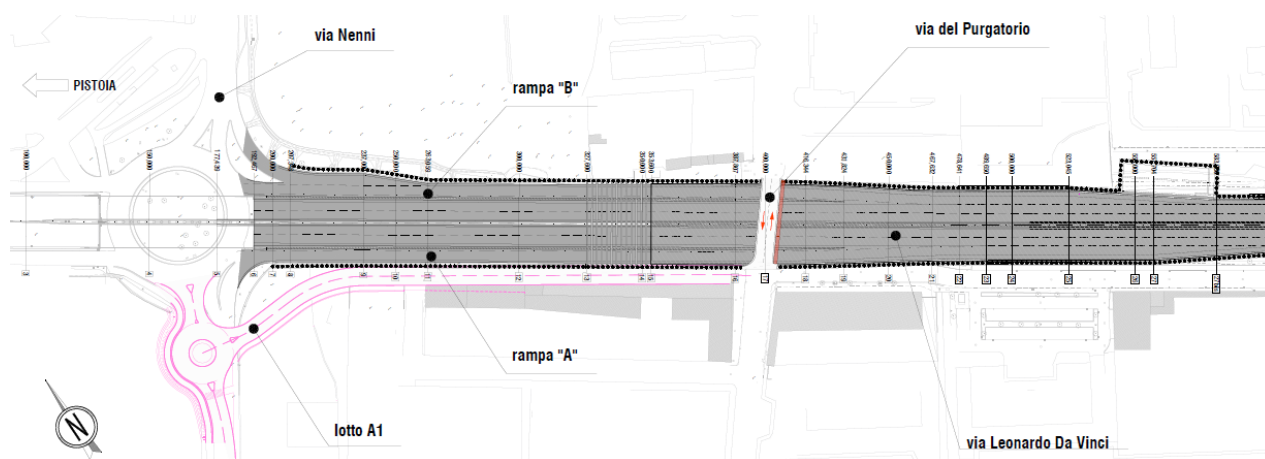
Stralcio planimetrico con indicazione delle rampe "A" e "B"
